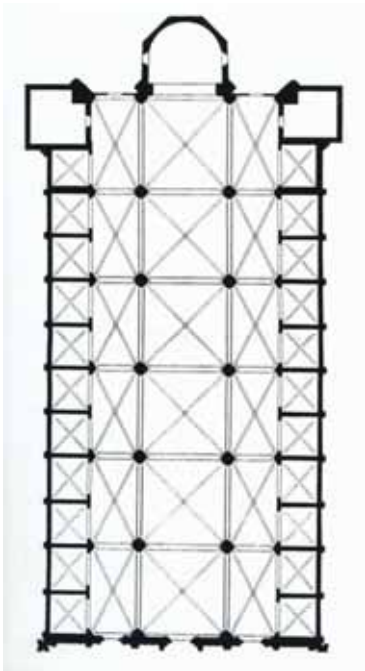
34 Grundrissplan *S. Petronio*, hinter der Apsis sieht man die Anschlussstücke für einen geplanten achteckigen Mittelteil
